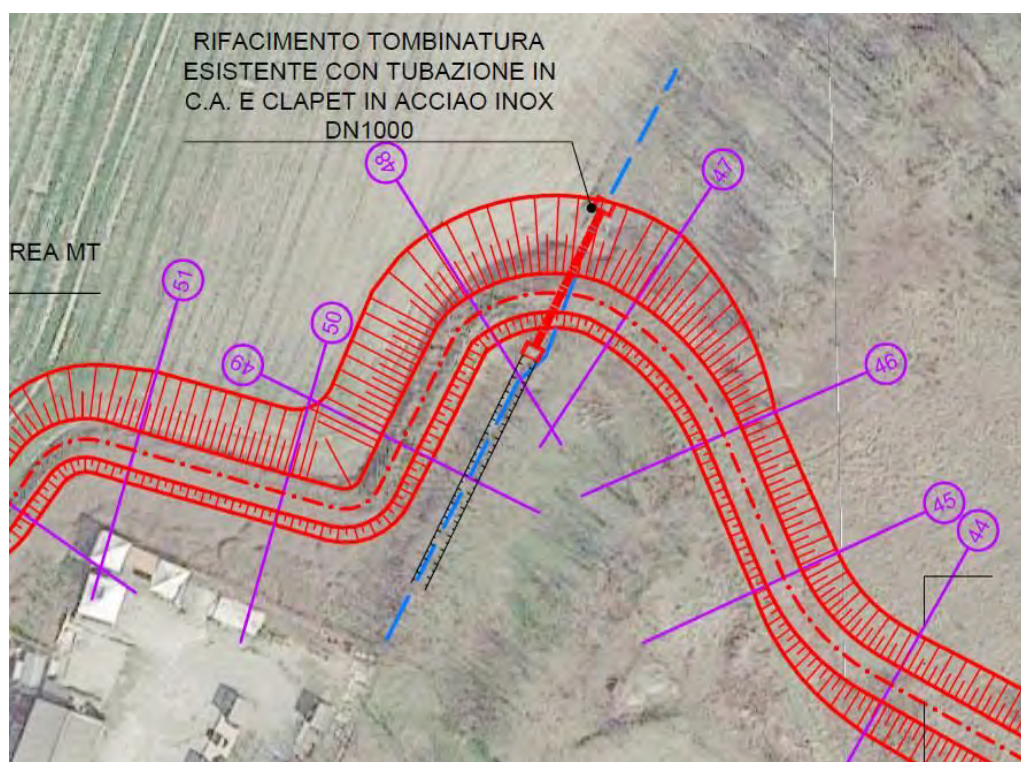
posizione scarico attraverso l'argine esistente oggetto di intervento di rialzo e ringrosso (stralcio planimetria di progetto).
